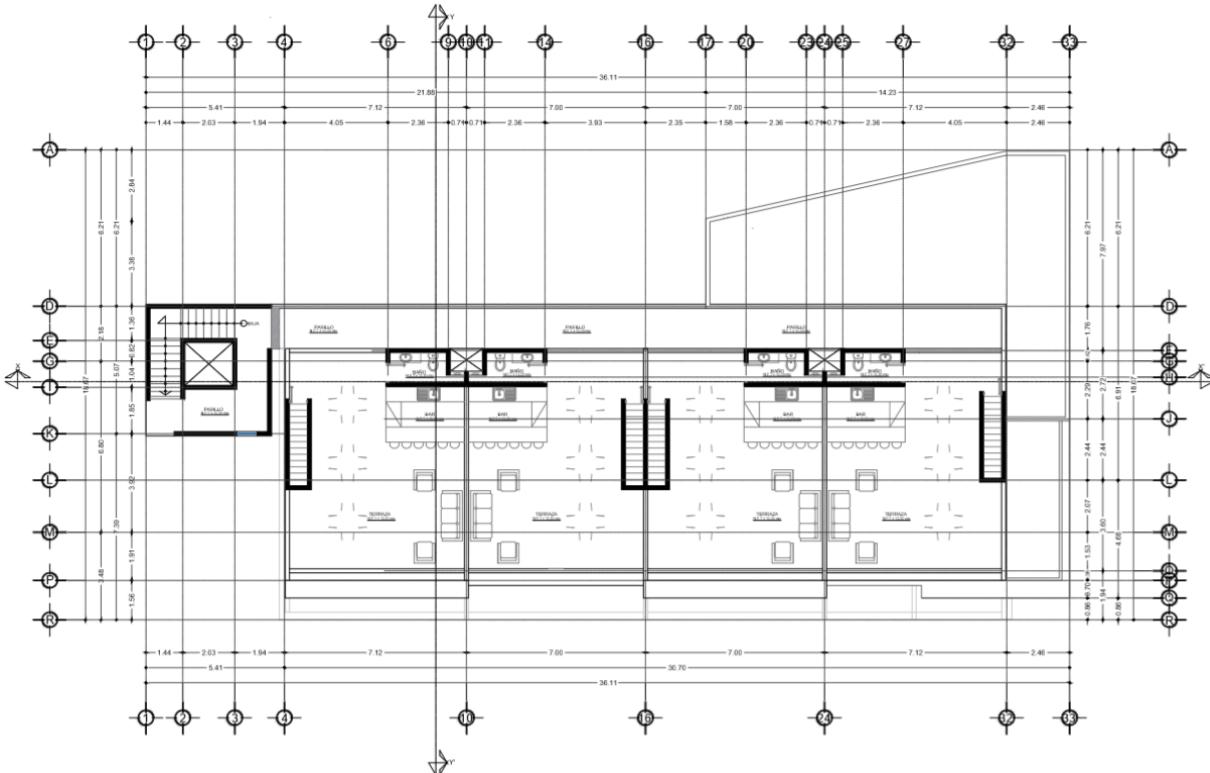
Planta arquitectónica del área de azotea del Edificio B.
